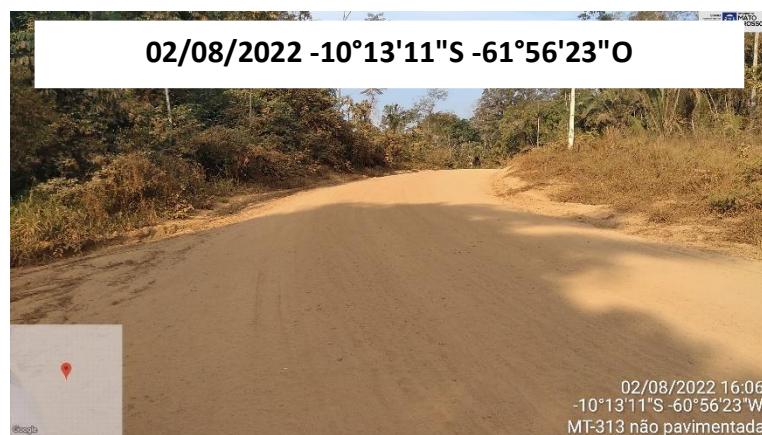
VISTA AO LONGO DO TRECHO MT-313
